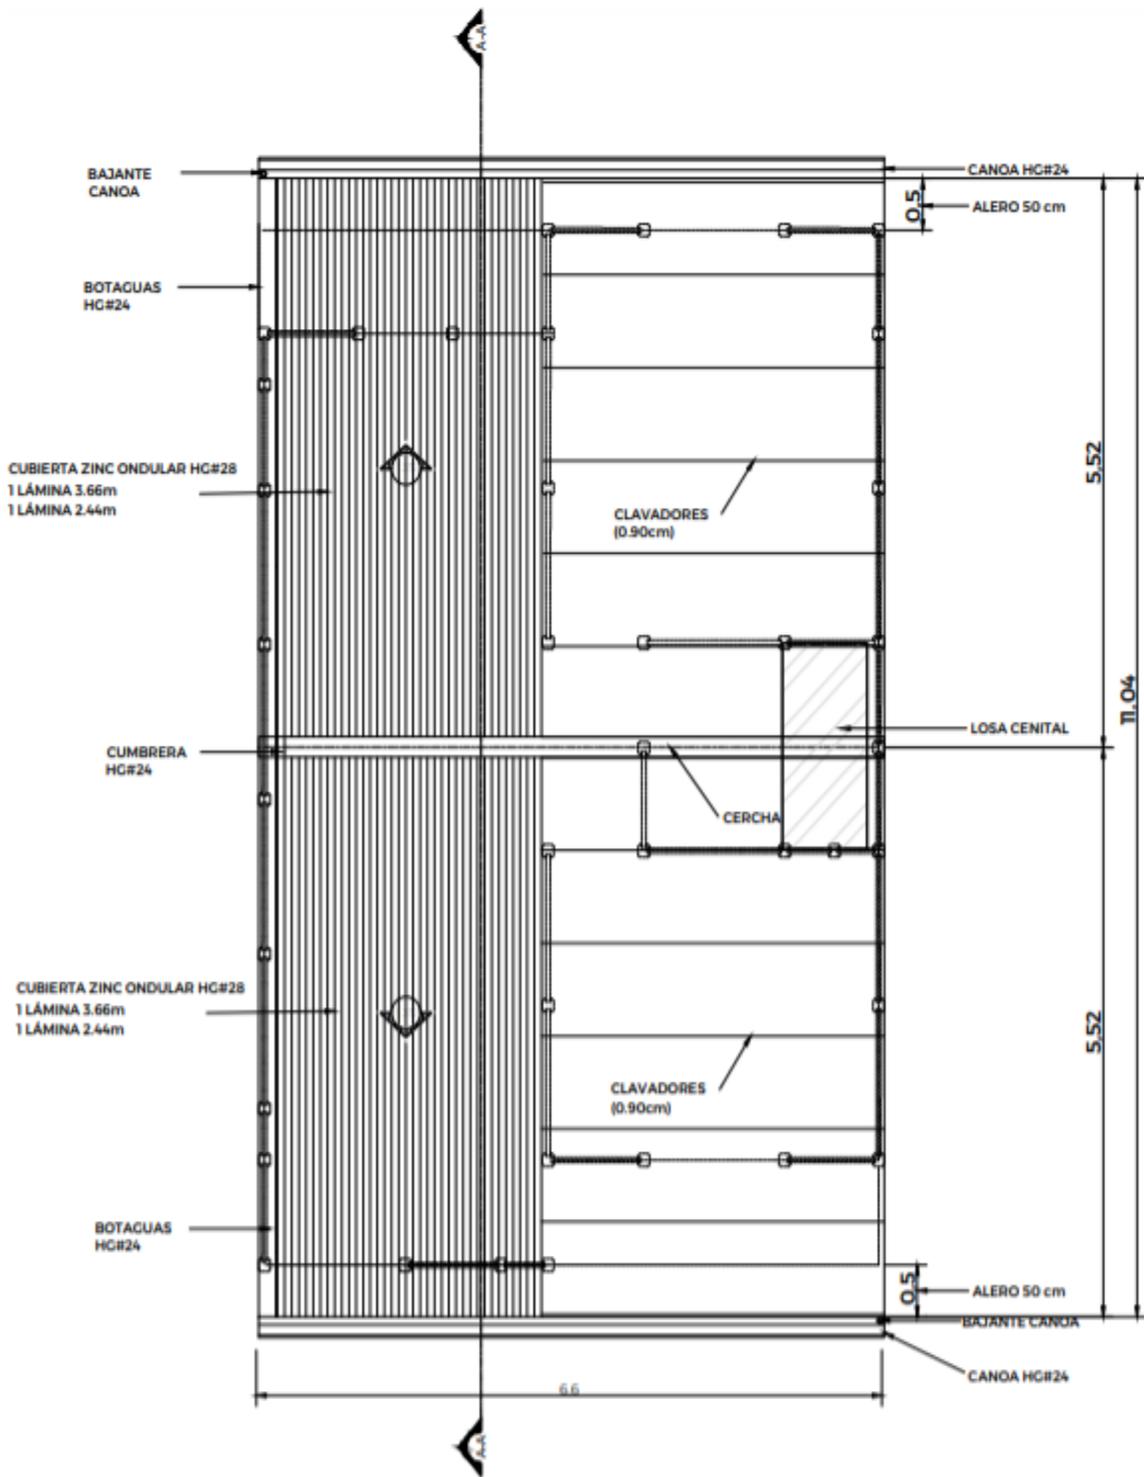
Detalle estructural de techos 1 agua Lamina Prefabricada - Sistema Constructivo Prefabricado- lamina prefabricada
